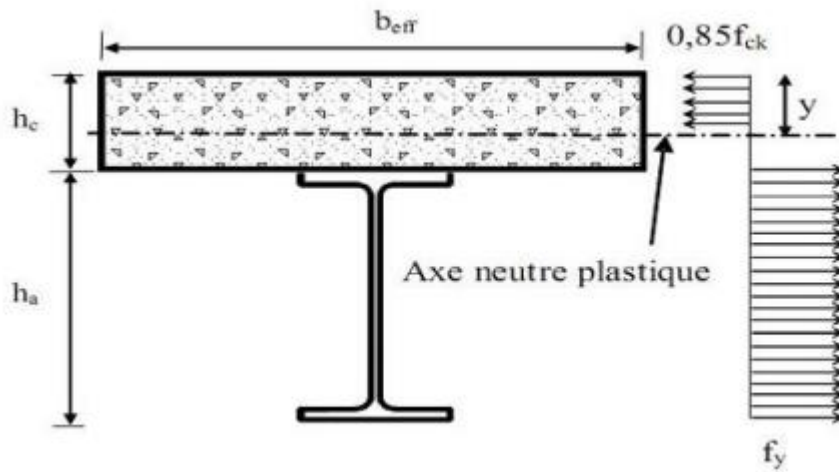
Axe neutre plastique de la poutre mixte dans la dalle.
